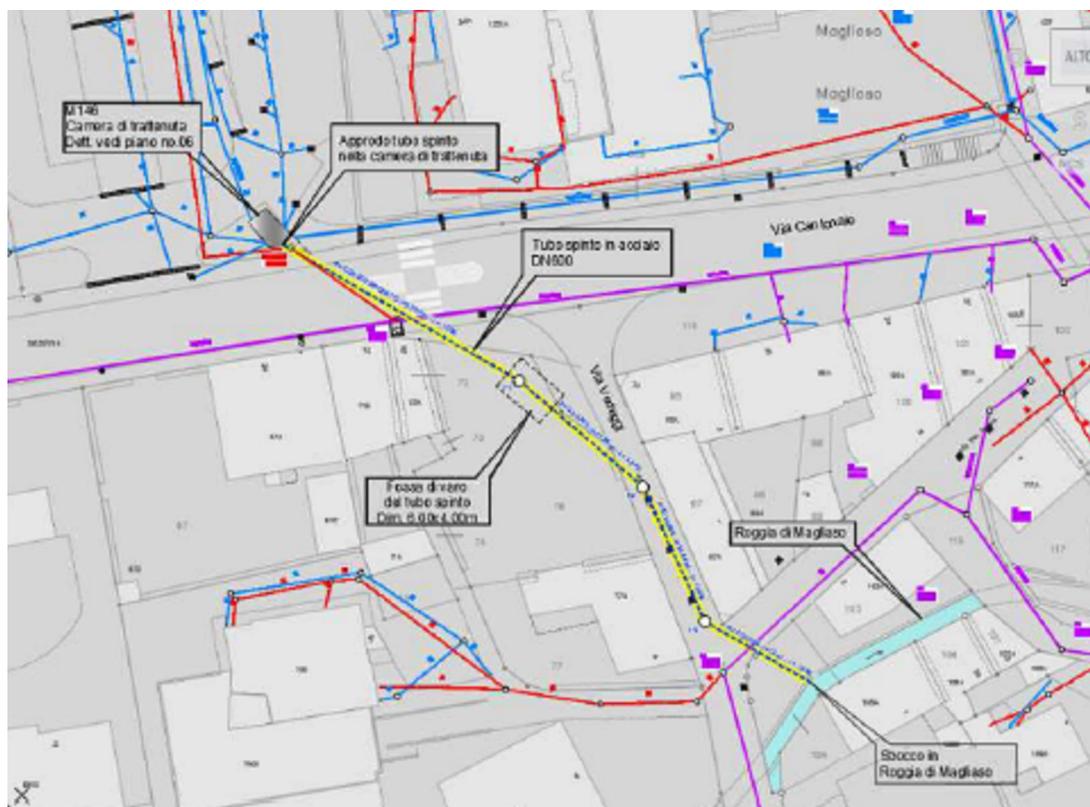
Stralcio planimetrico del tracciato (in giallo) di deviazione del riale delle Scuole
